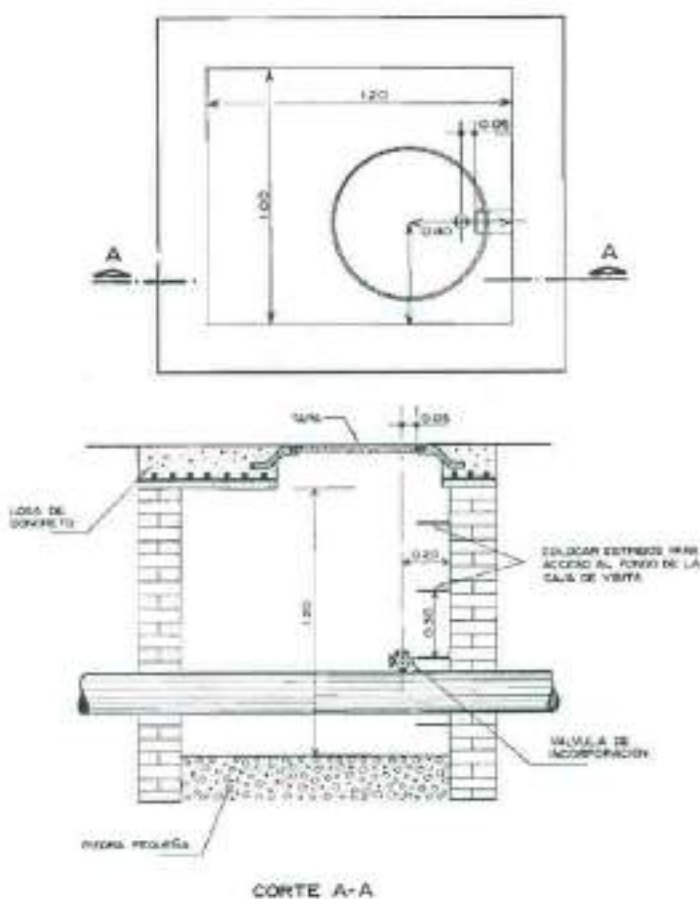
Caja de visita para proteger la Estación Pitométrica. (Dimensiones geométricas)
